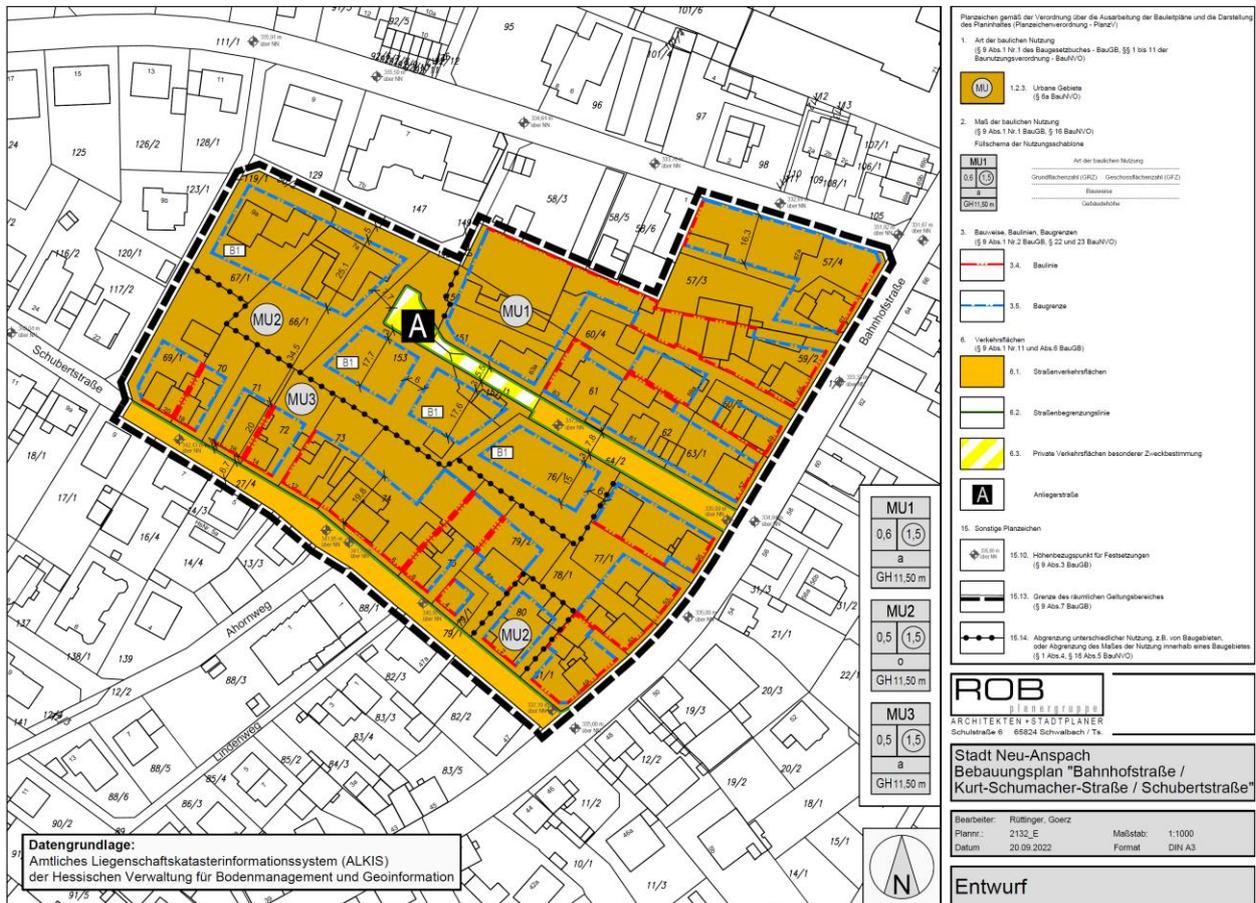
Planzeichnung des Bebauungsplans, Entwurfstand 20.09.2022
